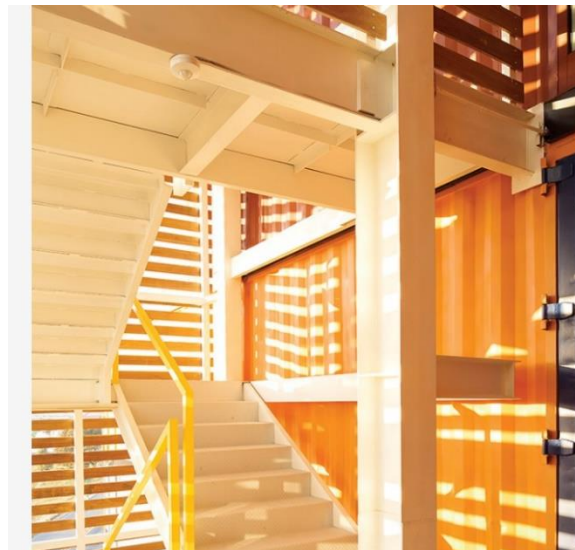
Vista de las escaleras muestra cómo se une la construcción tradicional con la construcción con contenedores. (Dwell, 2014)
